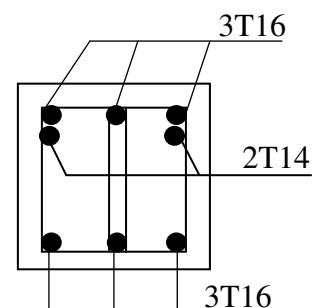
b.2. : Schémas de Disposition Du Ferrailage Des Poutres Secondaires
